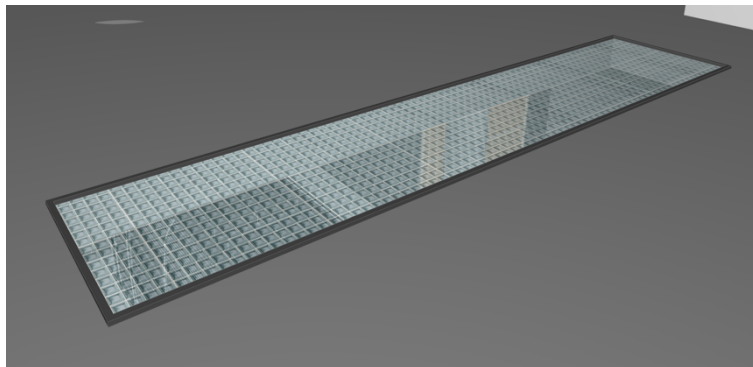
Forjado de la planta de garaje. Lucernario con vidrio U-Class. Fuente: Elaboración propia.
